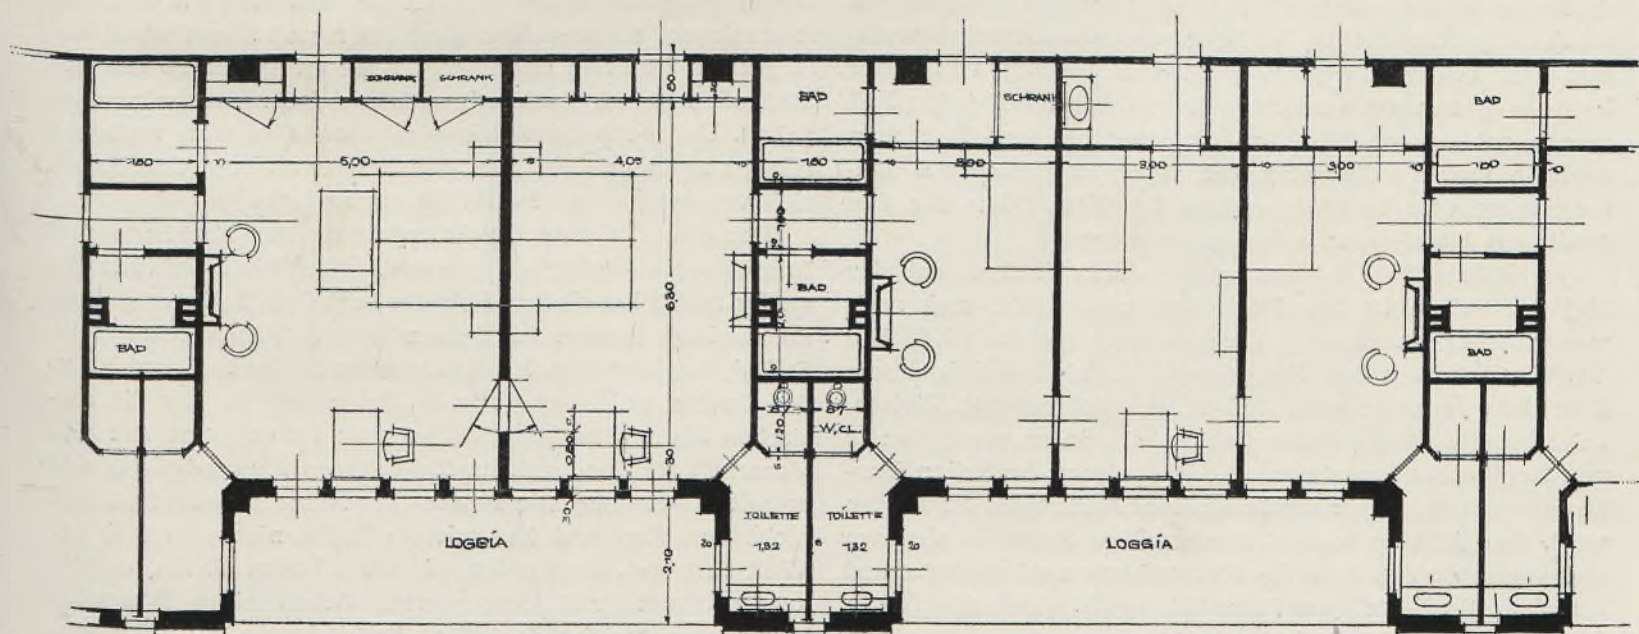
Peter Behrens, Hotelprojekt, Grundriß mehrerer Zimmer.
